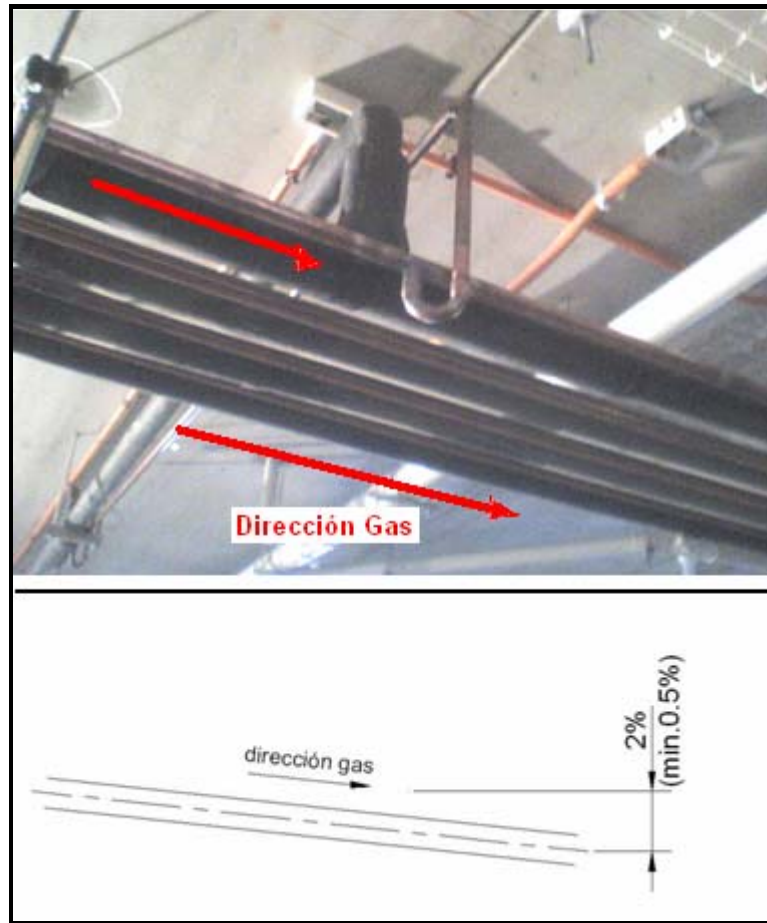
Grado de inclinación de tubería de succión hacia unidad condensadora
